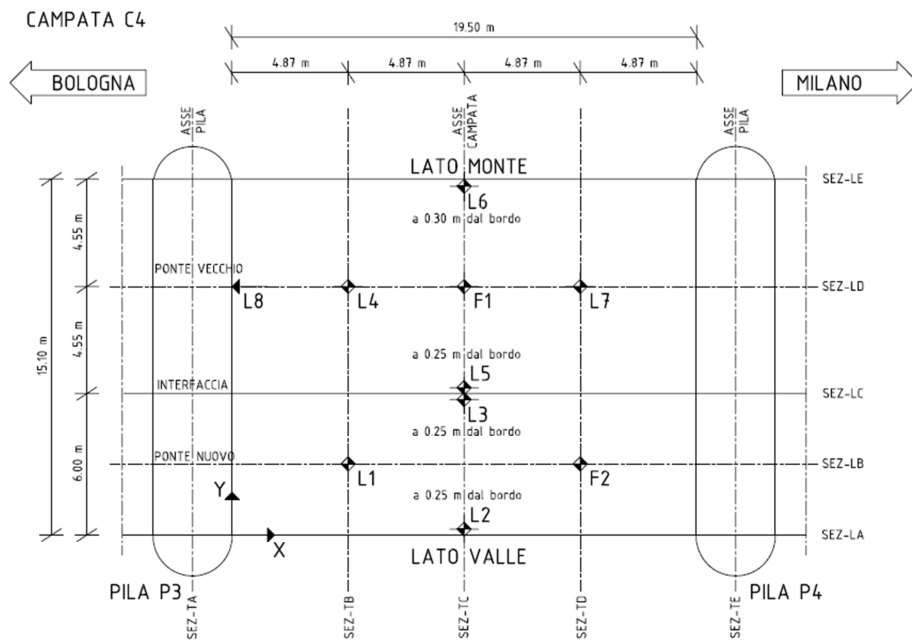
Disposizione degli strumenti nella prova di carico statico
